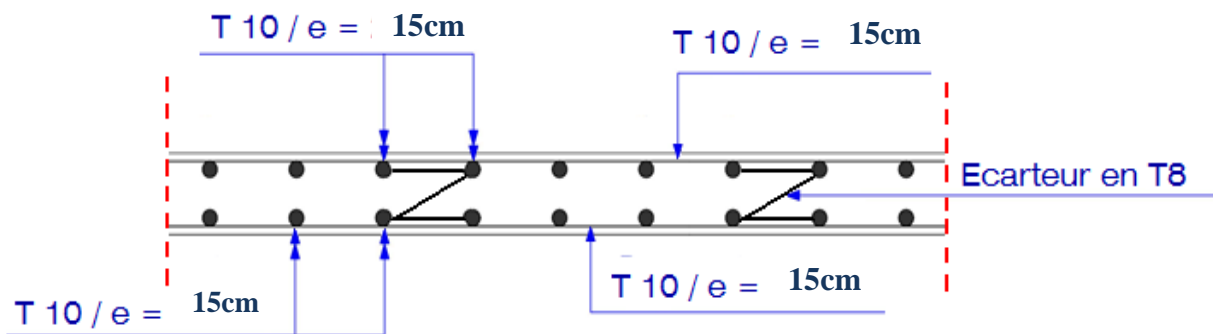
Coupe transversale au niveau de la dalle pleine.
